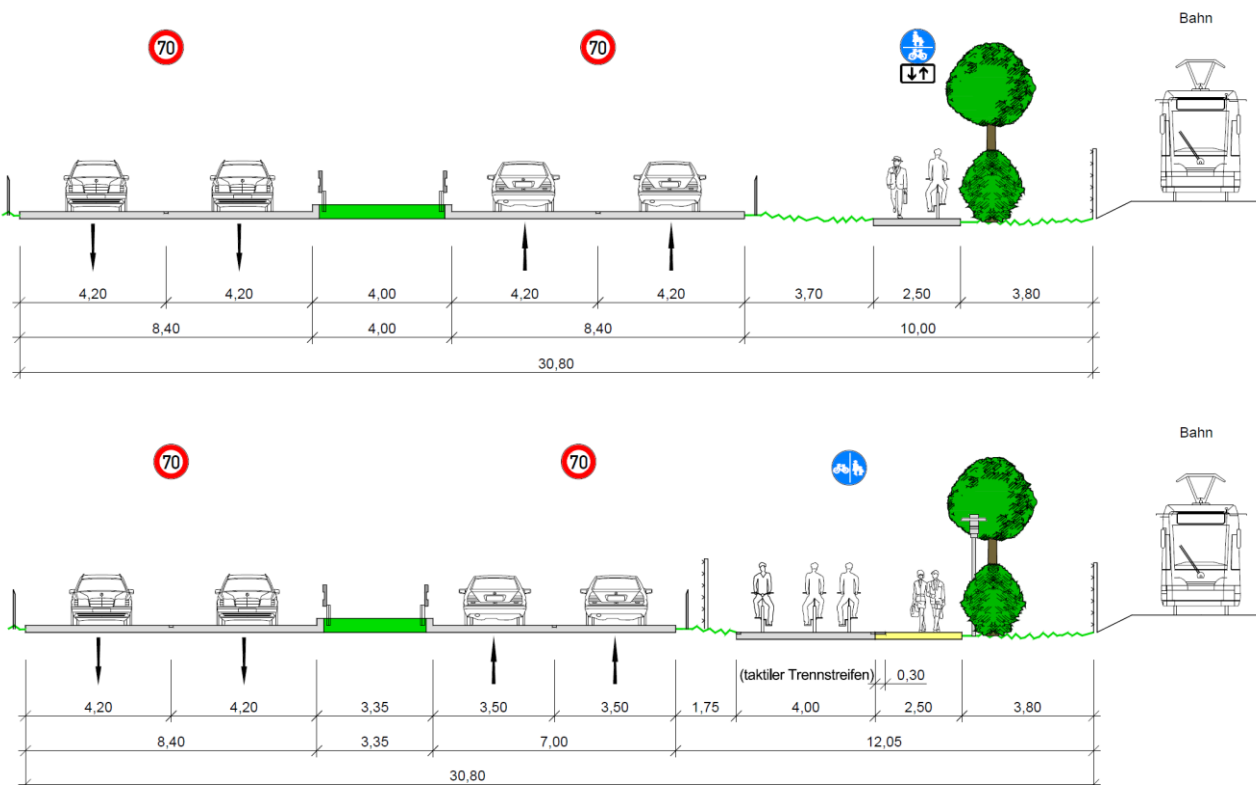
Ingolstädter Landstraße (Autoverwertung Rottegger bis Münchener Ring) – Bestand (oben) und Planung (unten)
